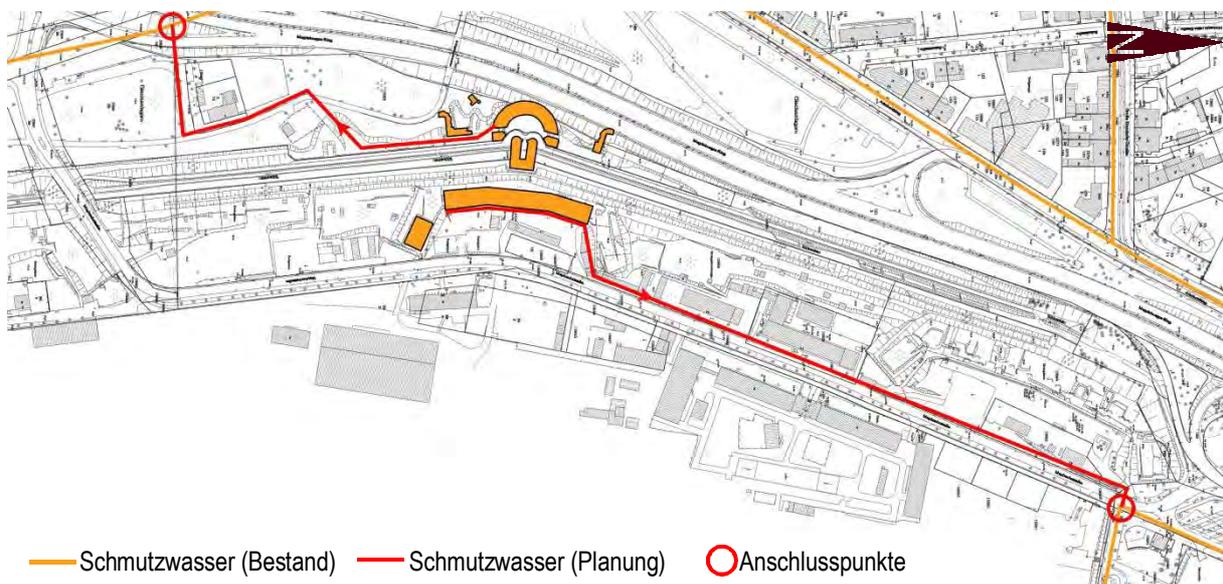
Schmutzwasserleitungen (Bestand und alternative Planung)
